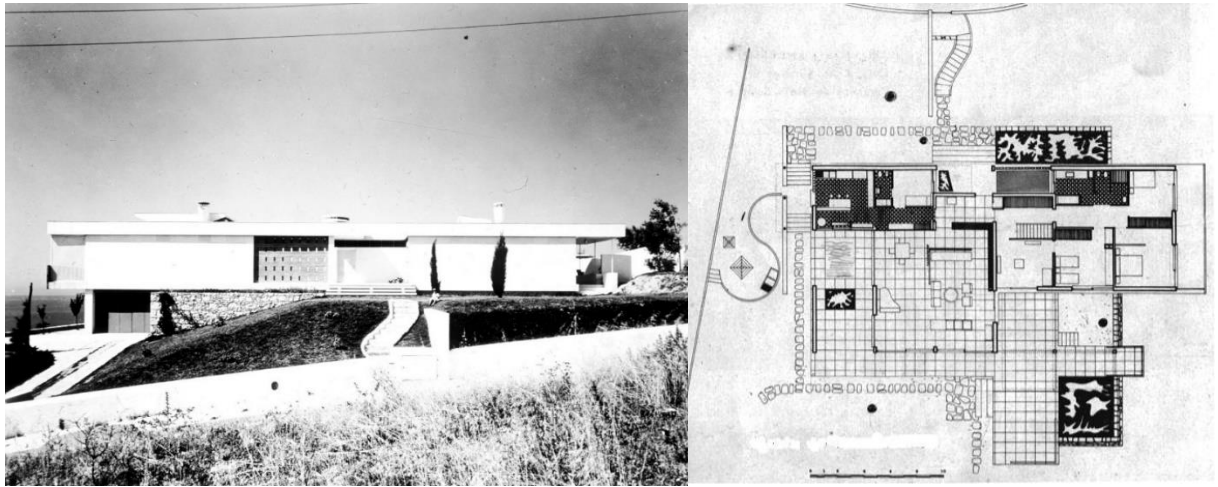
Vista exterior e planta Casa Lino GasparArquiteto João Andresen, Oeiras.
